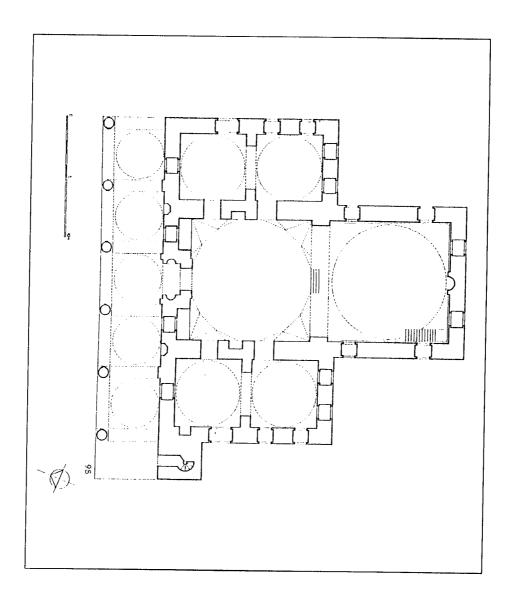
مسقط أفقي لمسجد الآجا (عمارت) إسحاق بك في أسكوب (عن: اصلان ابا)
